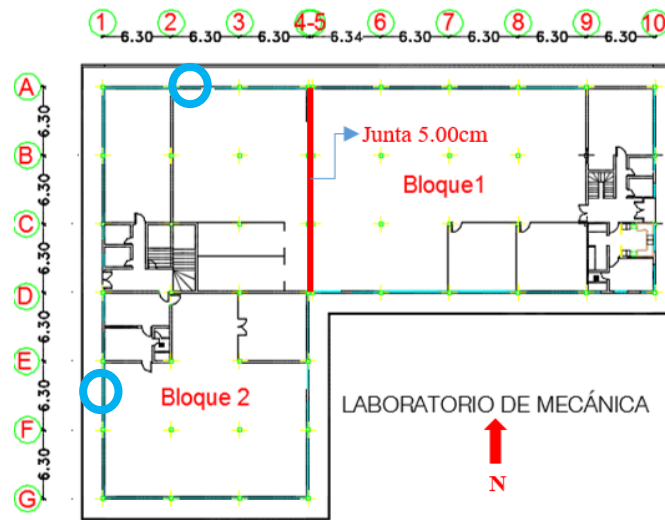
Ubicación en planta de acelerómetros en Bloque 2
